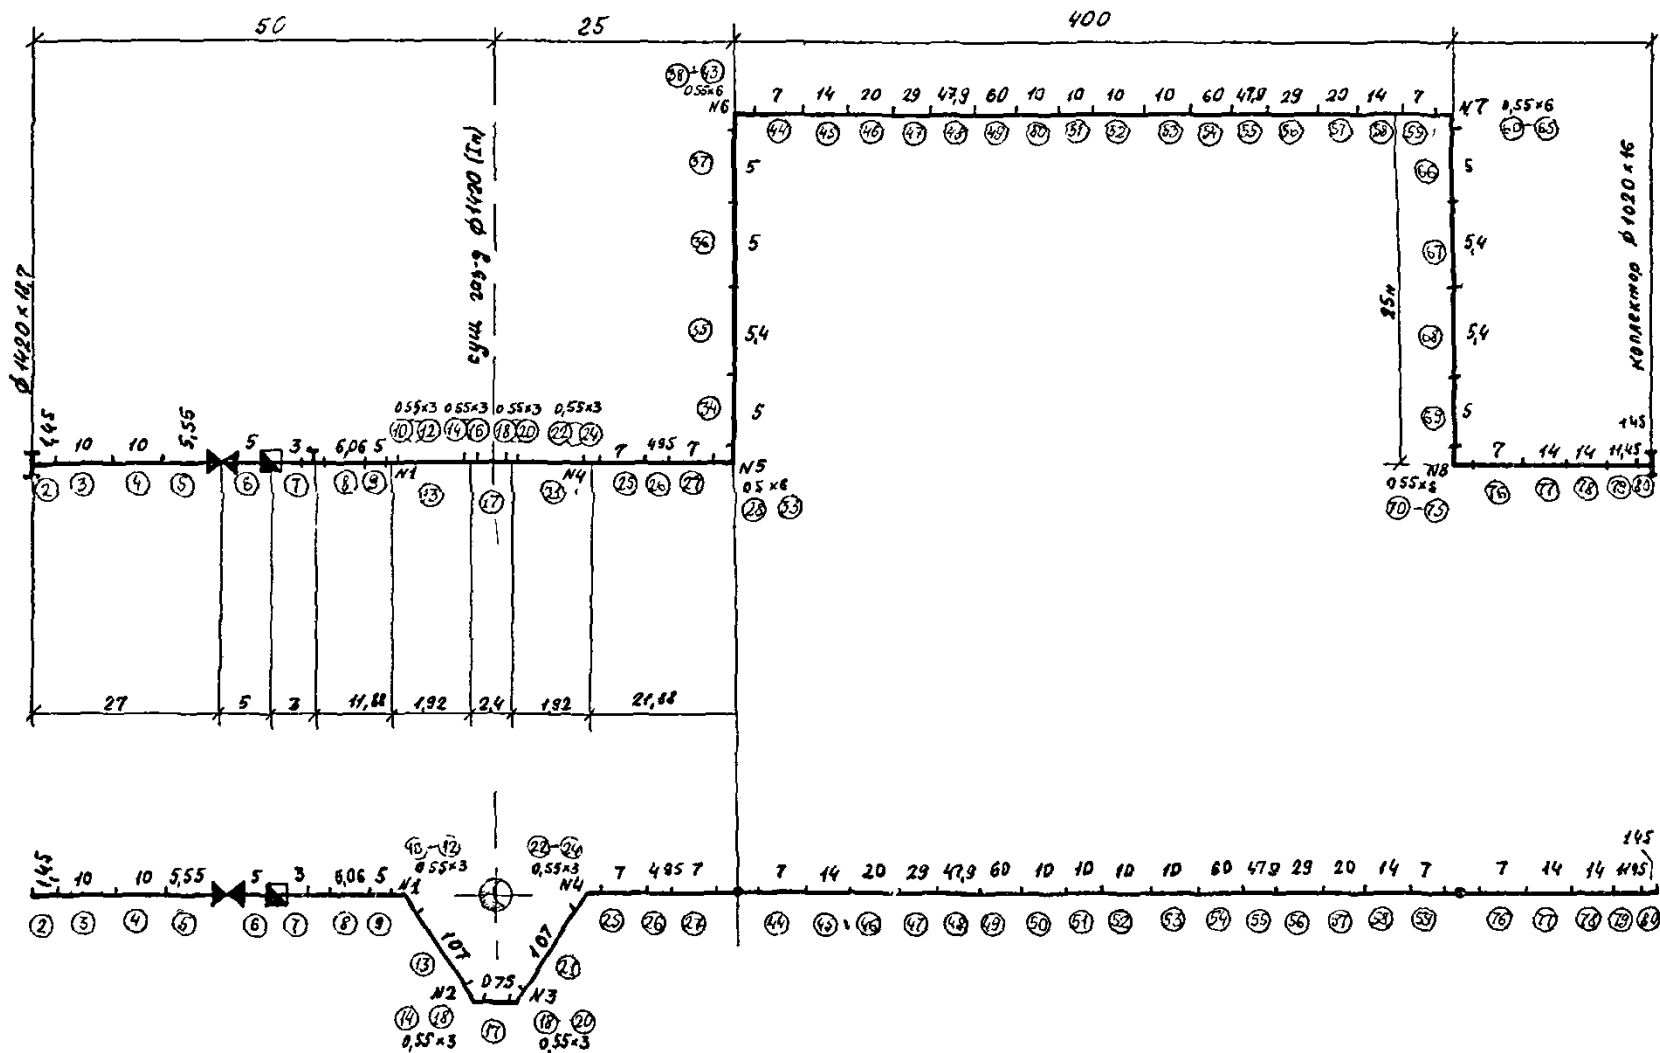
Схема плана и профиля рассчитываемого участка трубопровода
